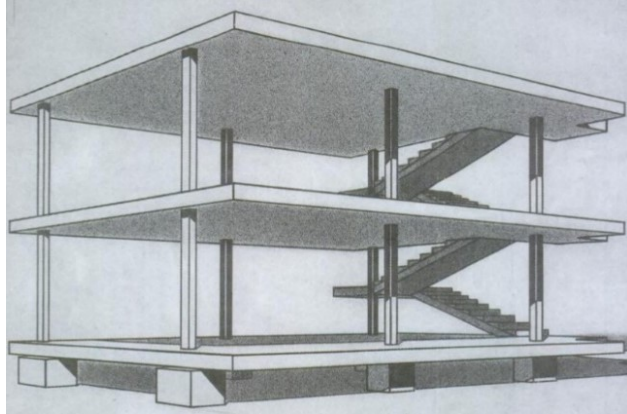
Maison Domino, tratto da "Contemporary Curtain Wall Architecture", Murray, 2019
